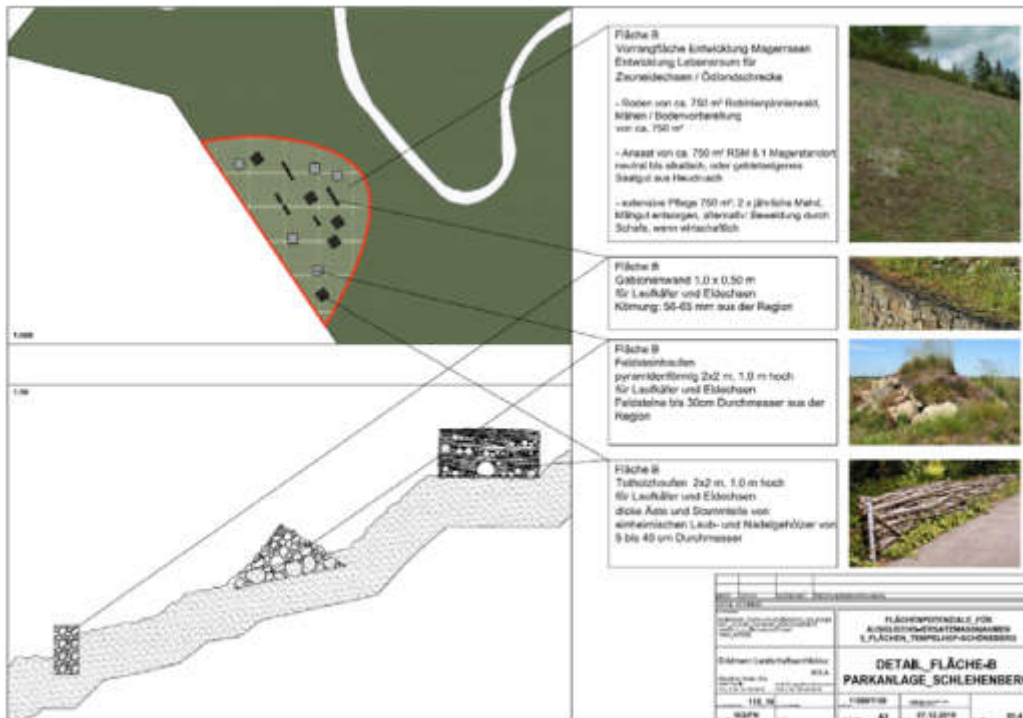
Detail Fläche B, Parkanlage Schlehenberg (Verkleinerung)
